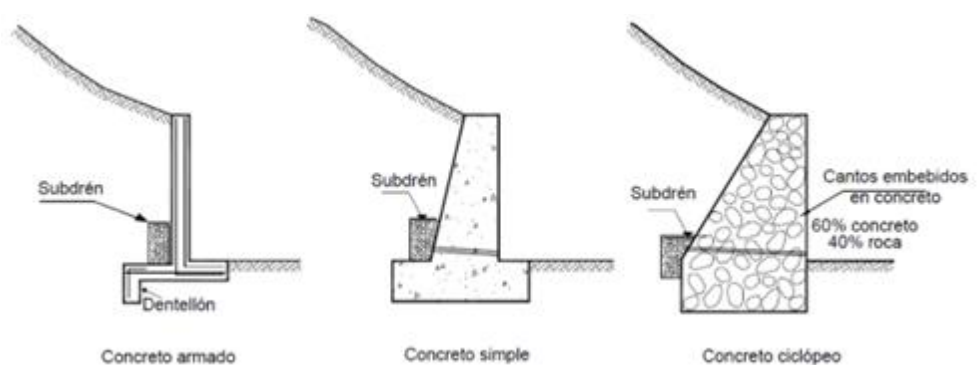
Muros de contención rígidos de a) concreto armado, b) concreto simple y c) concreto ciclópeo. Adaptado de Deslizamientos. Tomo II: Técnicas de Remediación, (p. 111), por Jaime Suárez, 2009, Colombia; modificado por Tovar, (2023). Derechos reservados por Jaime Suárez.
